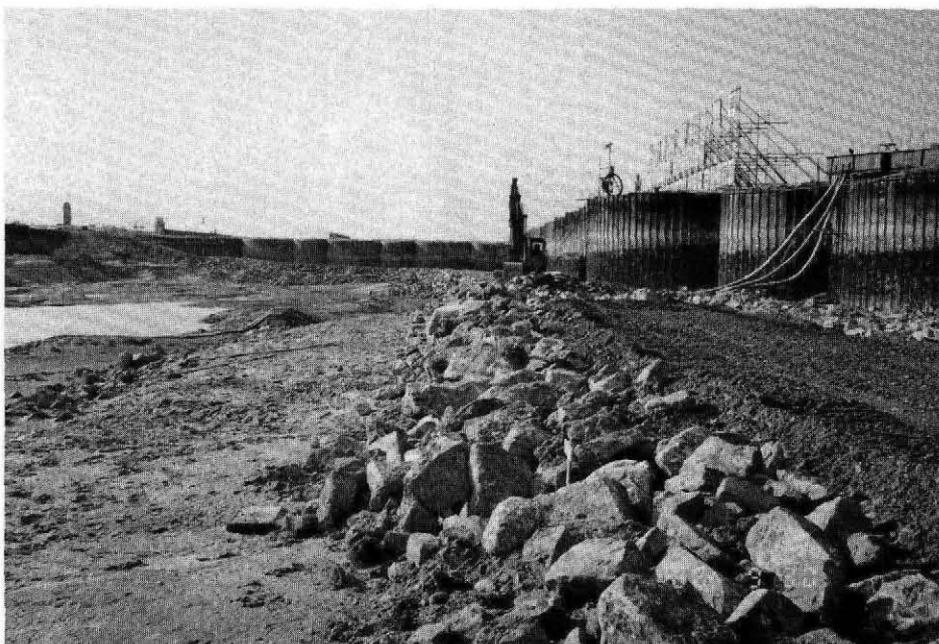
鋼矢板セル仮締切(根固め押え捨石)工法 水替後
